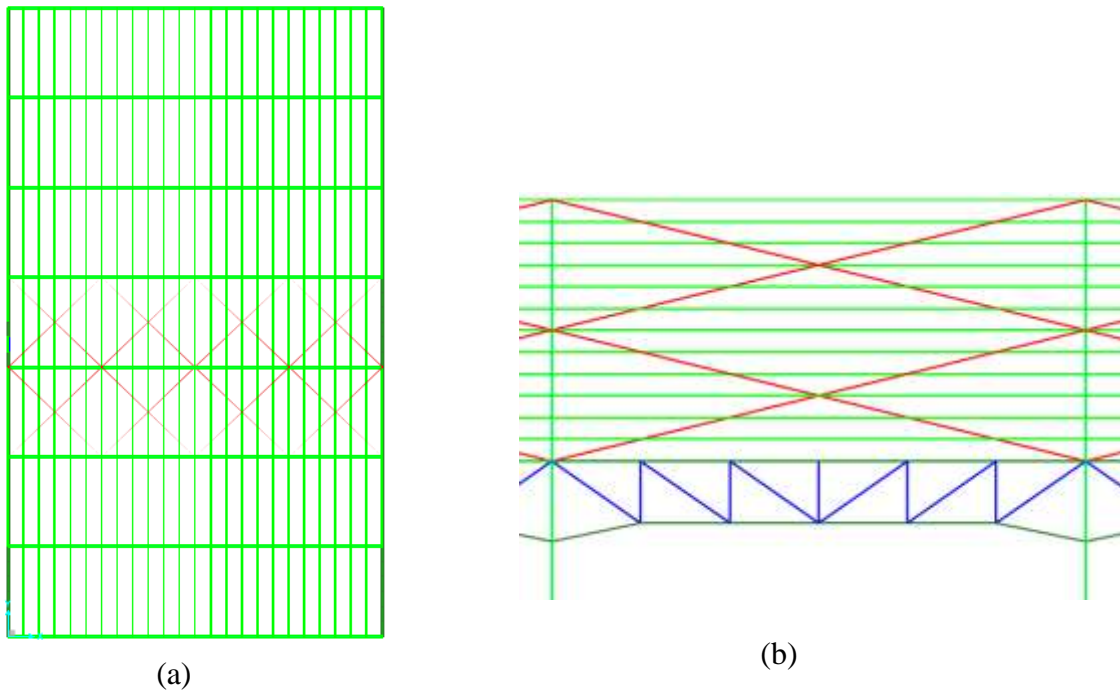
Vistas planta (a), Frontal (b) de la configuración estructural en SAP2000
